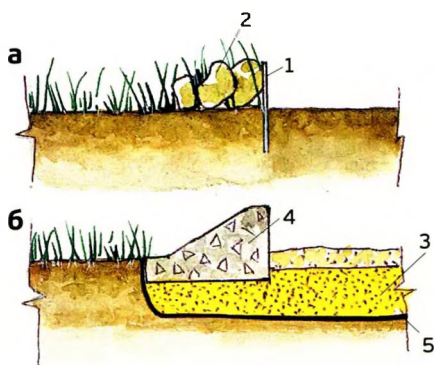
Конструкция бордюра бассейна: а — до реконструкции; б — после реконструкции; 1 — пластиковая бордюрная лента; 2 — камень (всухую); 3 — песчаная подушка; 4 — бетонный монолитный бордюр; 5 — чёрный спанбонд.
